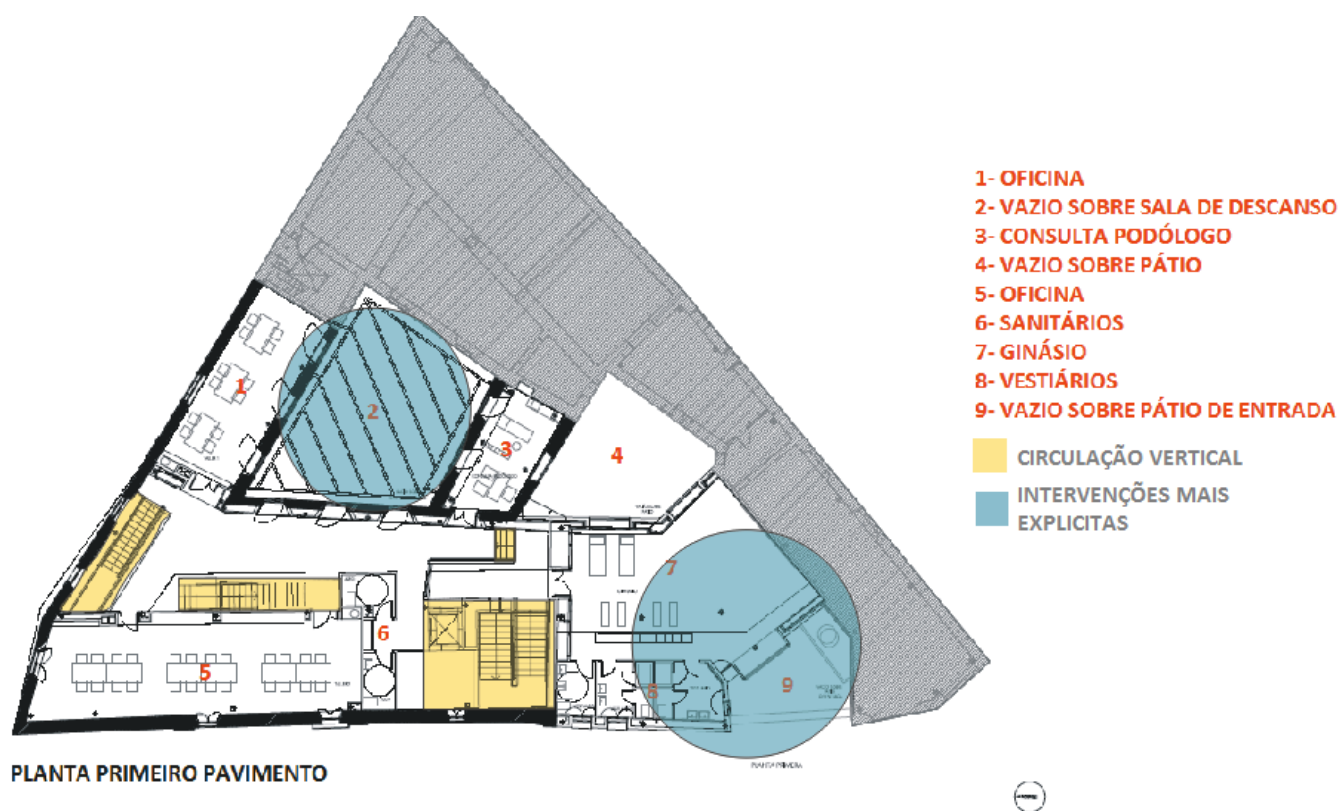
PLANTA 1º PAVIMENTO DA INTERVENÇÃO.
